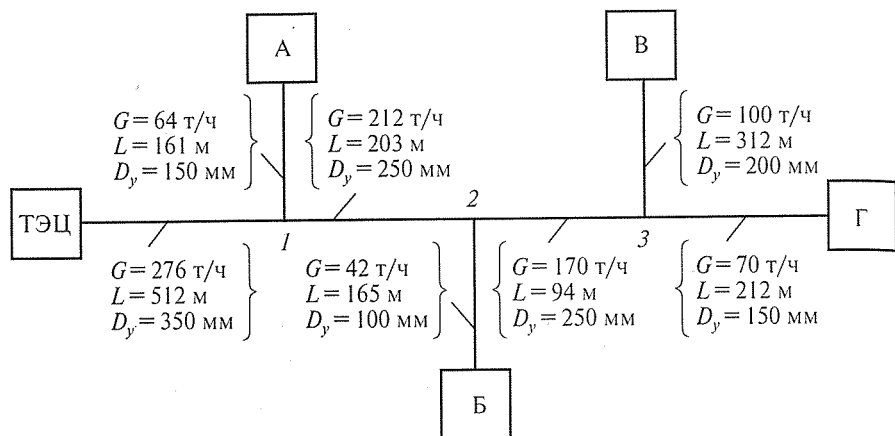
Расчетная схема для гидравлического расчета трубопроводов водяных тепловых сетей:
